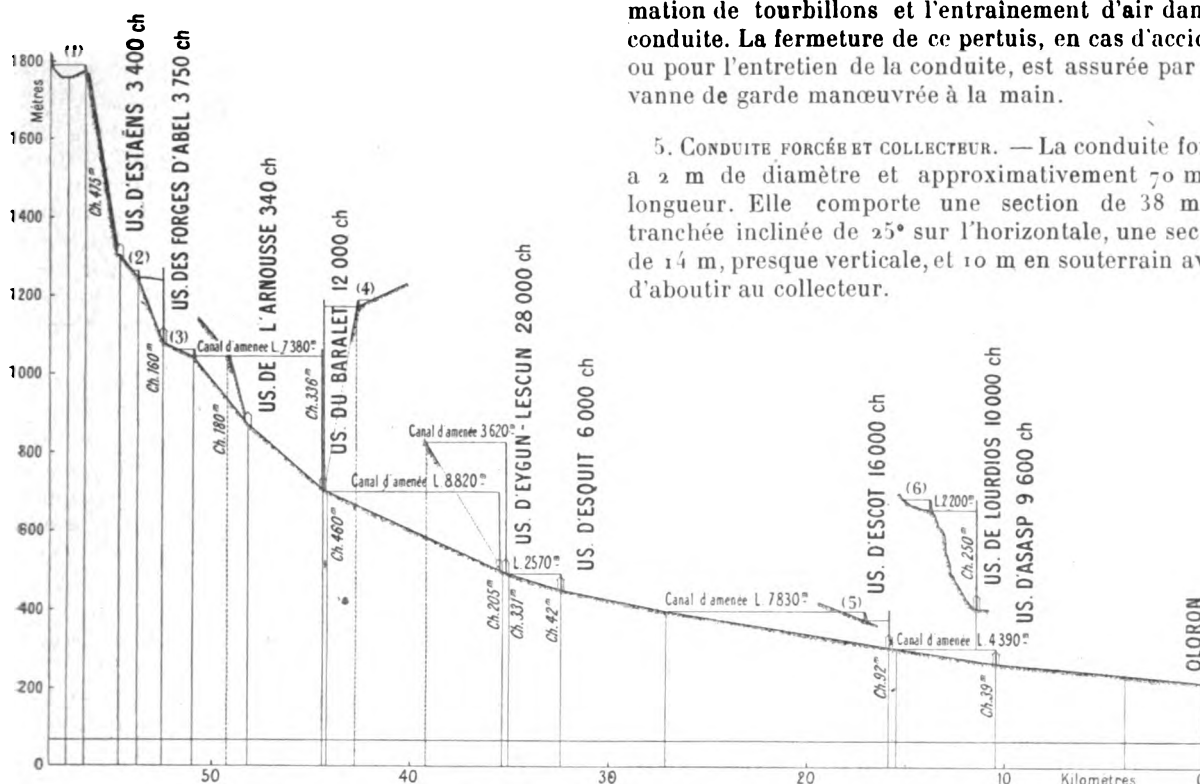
Profil en long de l'ensemble des installations hydrauliques du gave d'Aspe.
